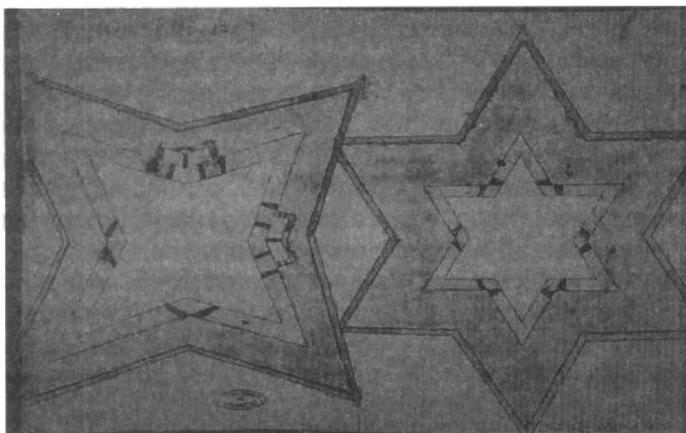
Proyecto de torres de planta estrellada para La Goleta.
